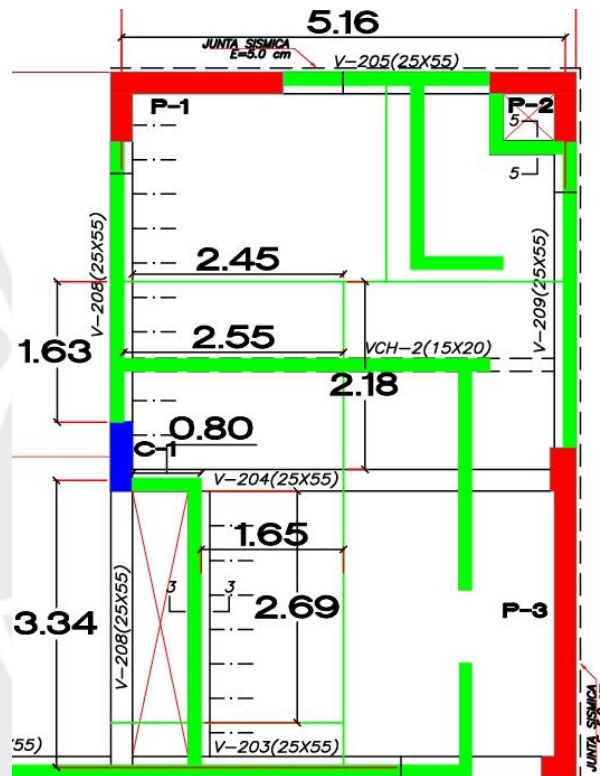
Planta de área tributaria de la columna C-1 del 1 piso
